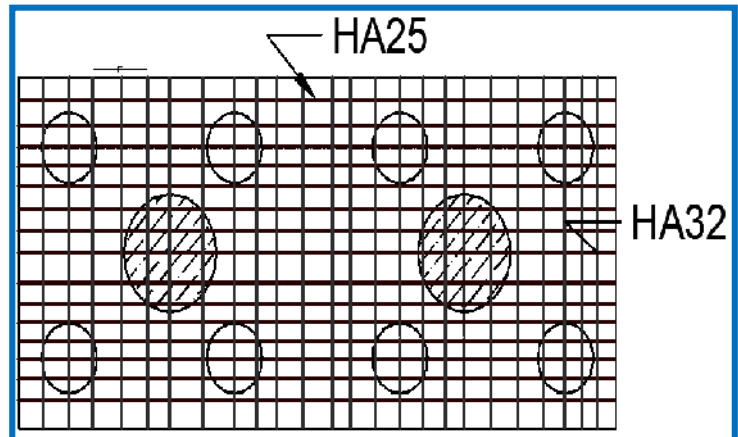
ferrailage de la nappe inférieure de la semelle
